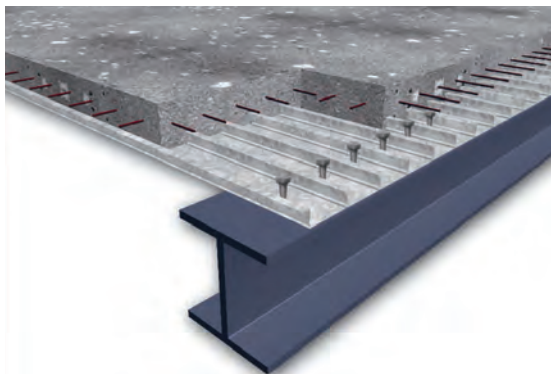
Сталежелезобетонные перекрытия с монолитной плитой с несъемной опалубкой из профилированного настила и стад-болтов
